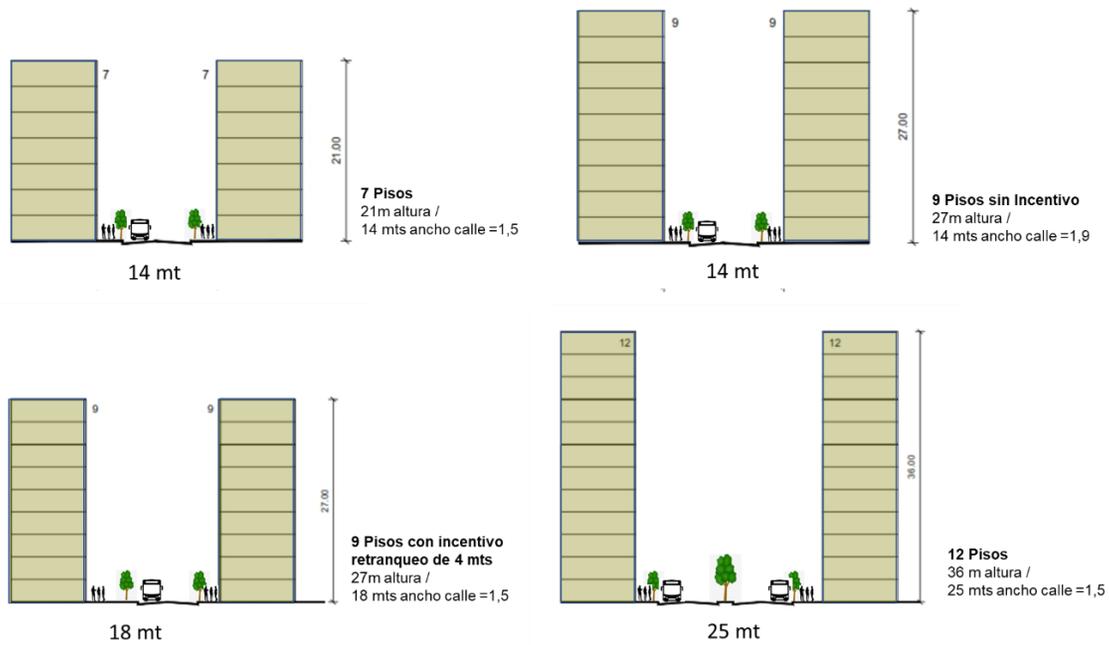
Esquema de la relación propuesta entre altura de edificios y ancho de las calles existentes
